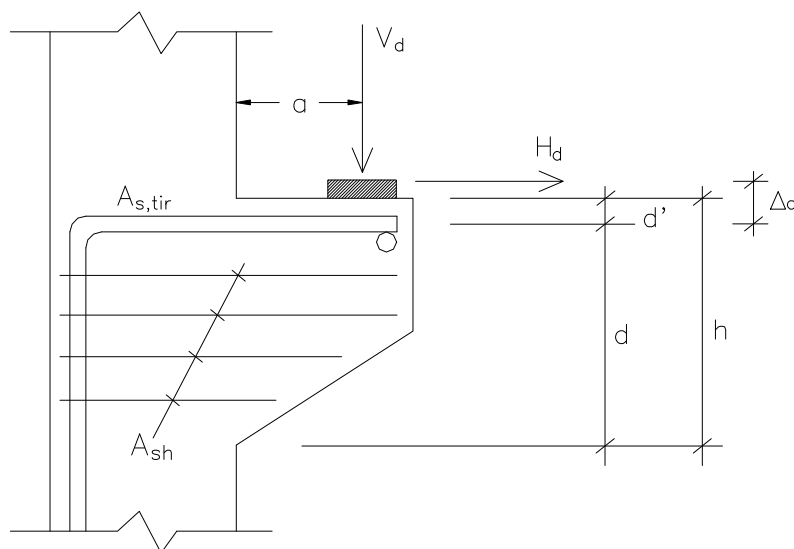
Esquema de Cálculo da Ligação Articulada
